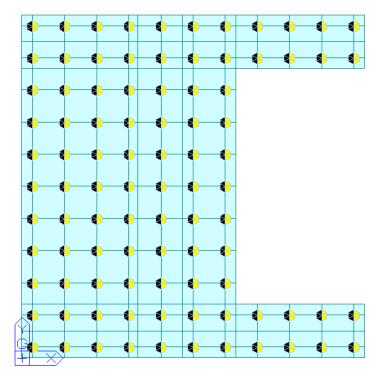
Vista 3D planimetrica del modello di calcolo Spalle
